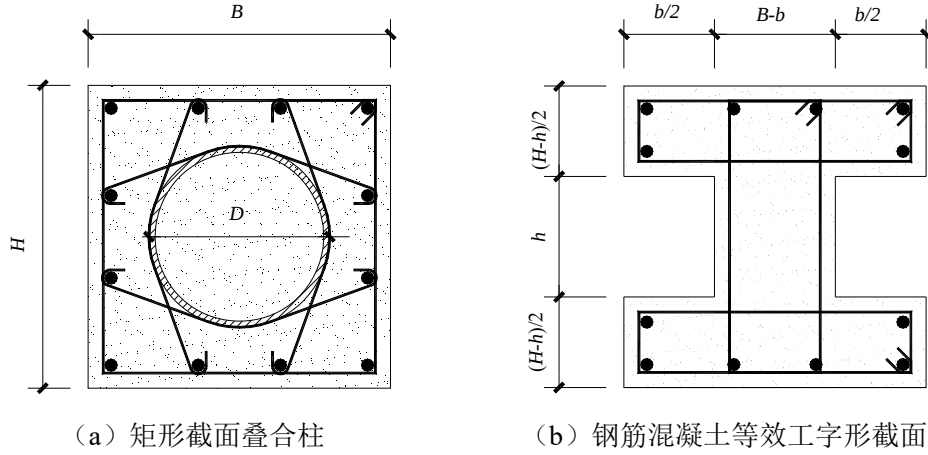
叠合柱管外钢筋混凝土等效工字形截面
